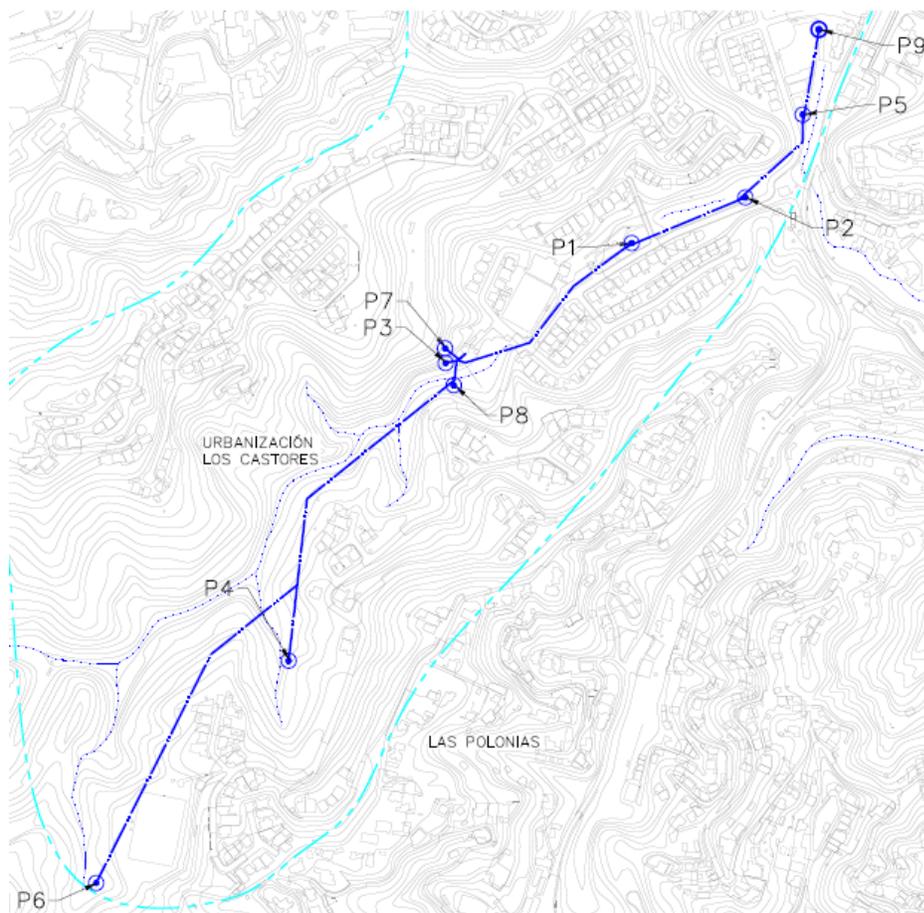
Plano de planta con la ubicación de las fuentes de abastecimiento.
